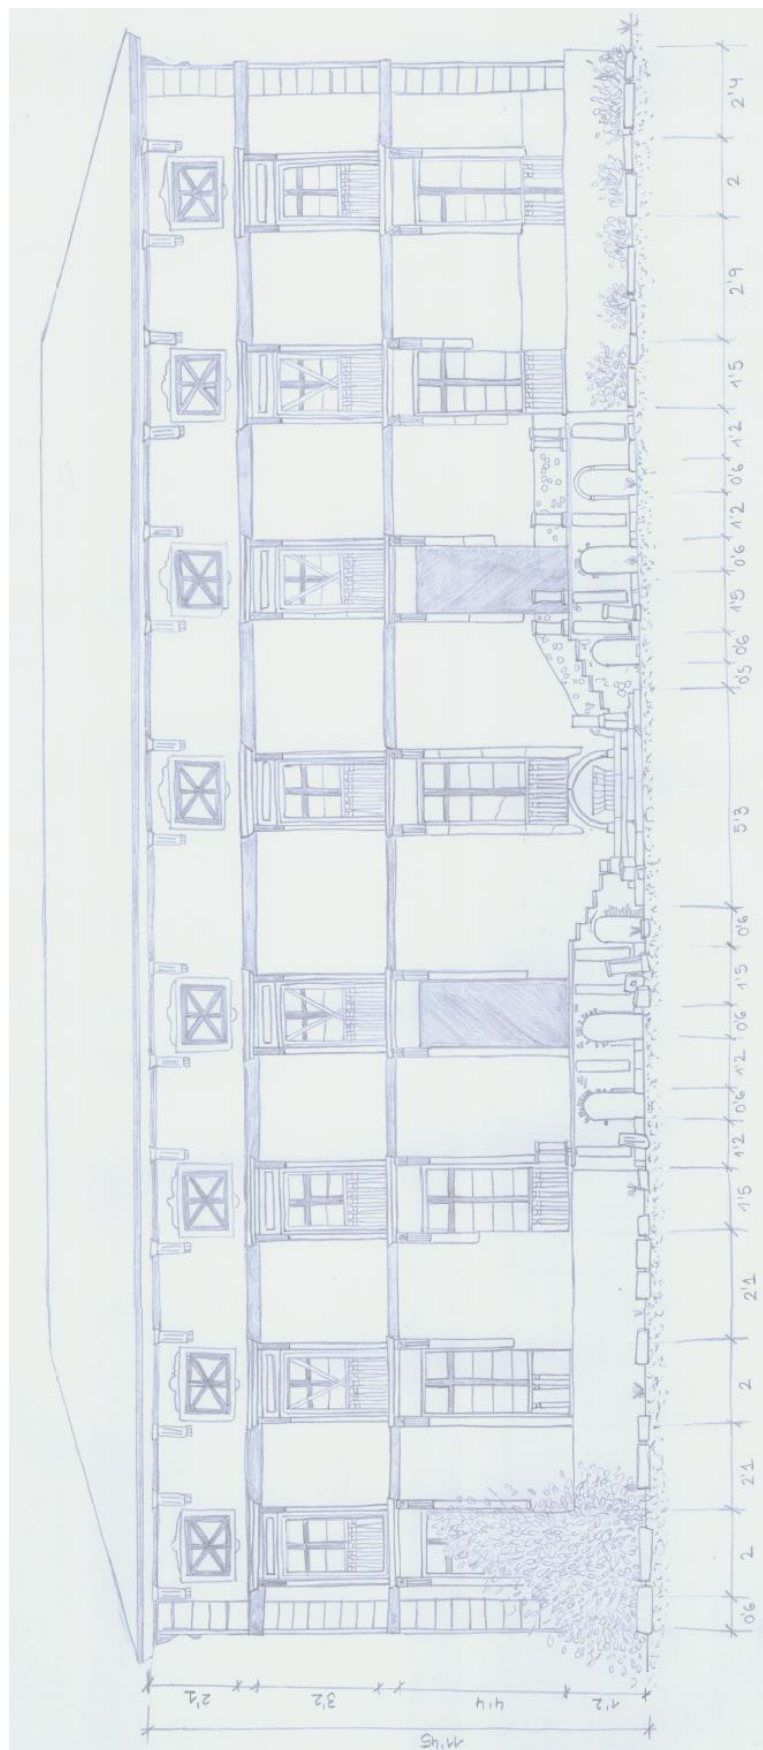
Alzado Jardín Principal. Fuente: Elaboración propia
